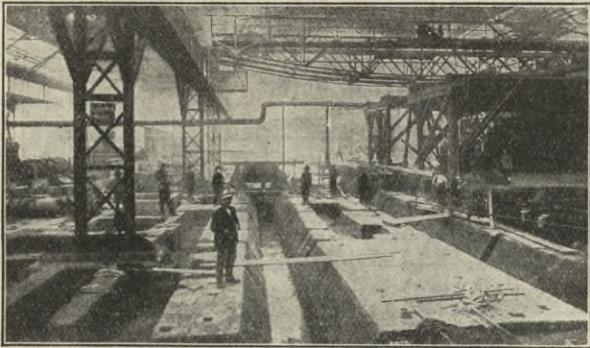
Westfälische Stahlwerke. Fundamente einer Walzenstraße.
